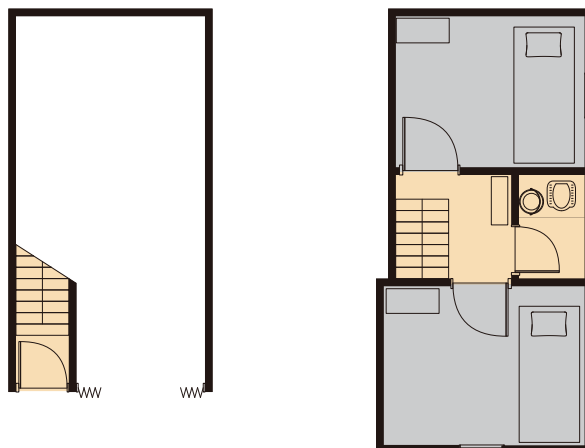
コス⑦；1 階平面図（左）と 2 階平面図（右）（1:50）
